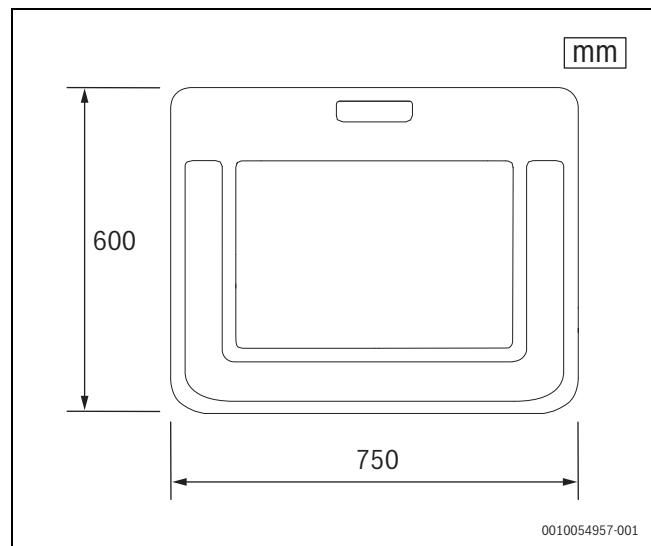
Dimensions des pièces latérales de la fondation préfabriquée
